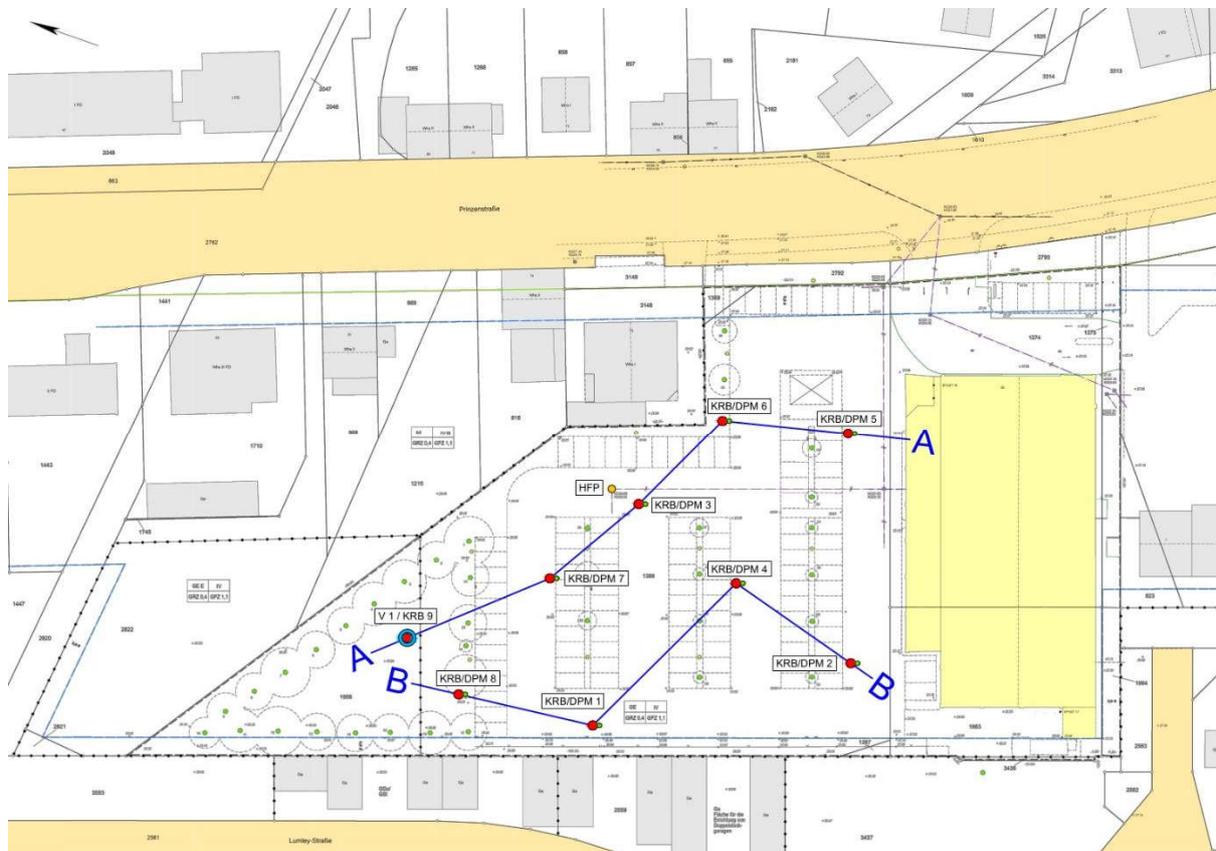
Ausschnitt aus dem Lageplan „Lage der Aufschlusspunkte“ aus der Baugrundbeurteilung der GFP GmbH (2021). Rote Punkte = Kleinrammbohrung (KRB), Grüne Punkte = Rammsondierung (DPM) und blaue Umringe = Versickerungsversuch (V).
